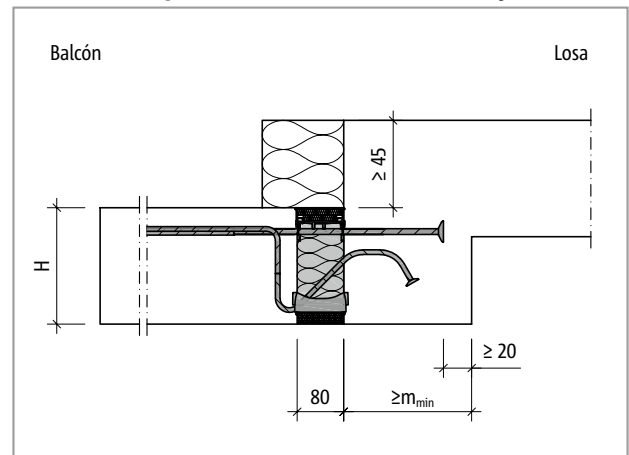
Schöck Isokorb® T tipo K-U: Balcón con desplazamiento de altura hacia abajo y aislamiento externo
